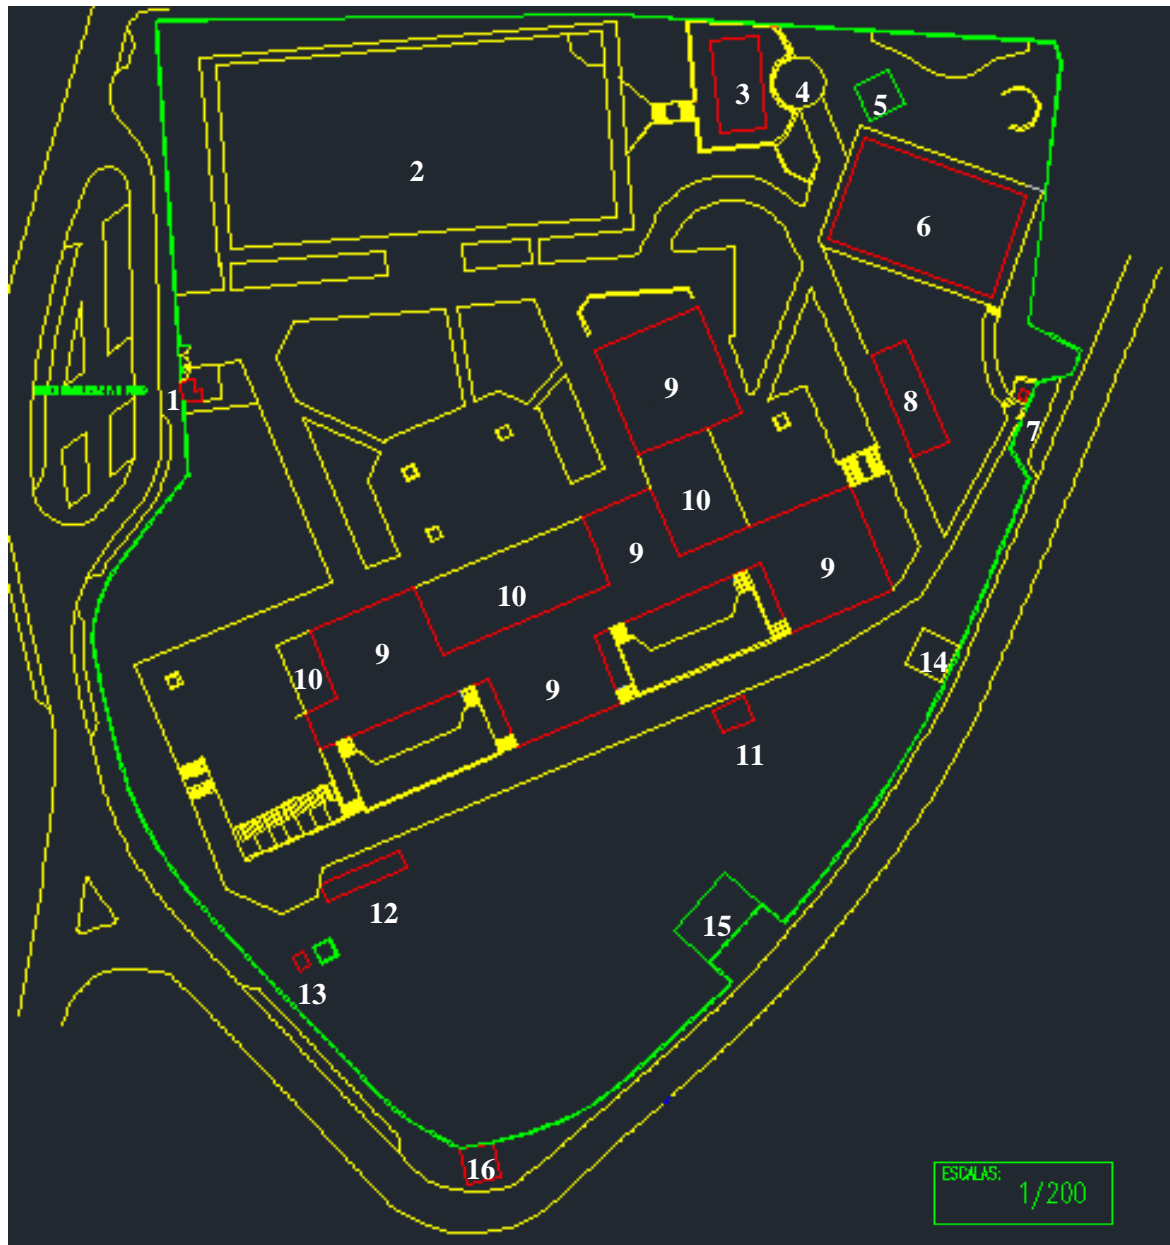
Planta da Escola EB 2,3/S Pedro Ferreiro.
